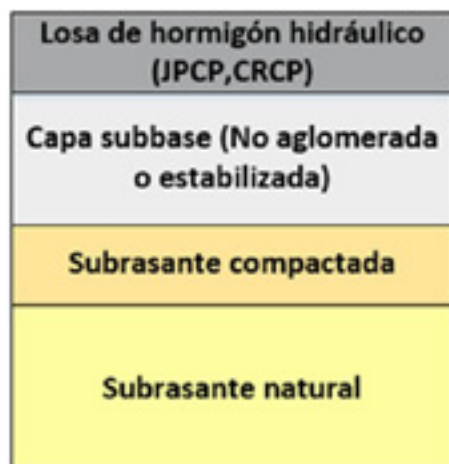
Sistemas de capas. Modelo de estructuras posibles de pavimento rígido
